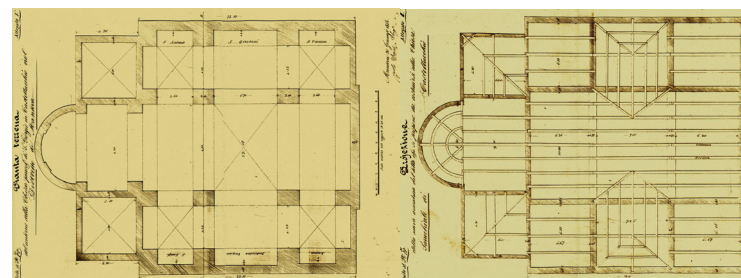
PLANIMETRIA SETTI, VOLTE E SOTTOTETTO DEL 1858. RIPRODUZIONE DEI DISEGNI DELL'ING. IVANI PRODOTTI PER LE OPERE DI RIFACIMENTO DELLA COPERTURA
